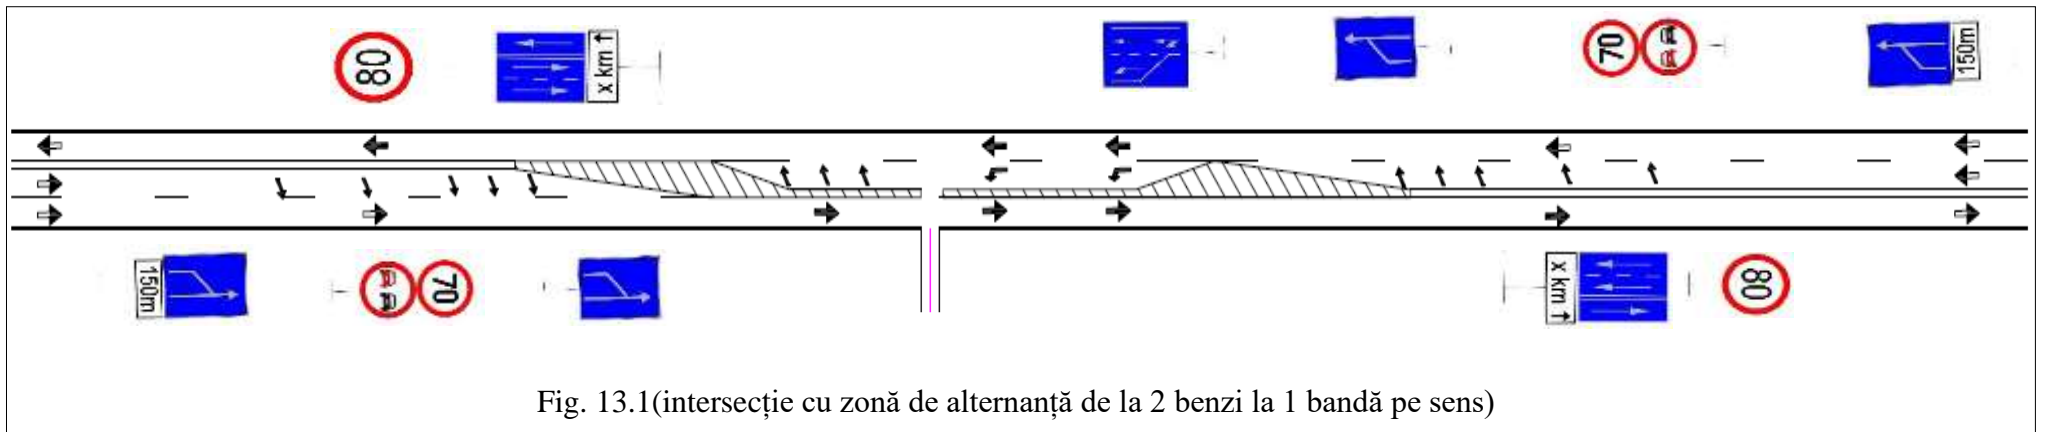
(intersecție cu zonă de alternanță de la 2 benzi la 1 bandă pe sens)
